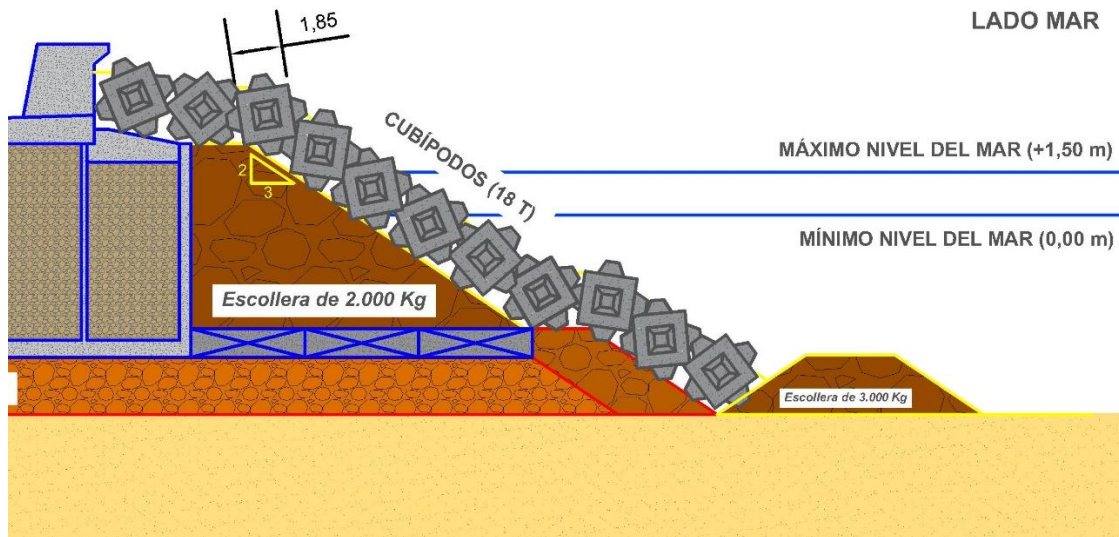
Sección tipo de la alternativa E. Cotas en metros.
